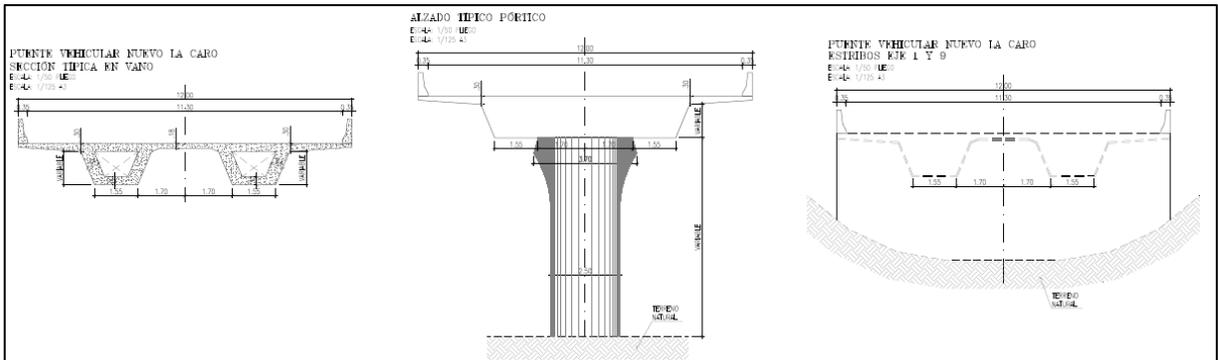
Vista General Puente La Caro Nuevo estribos y pilas
